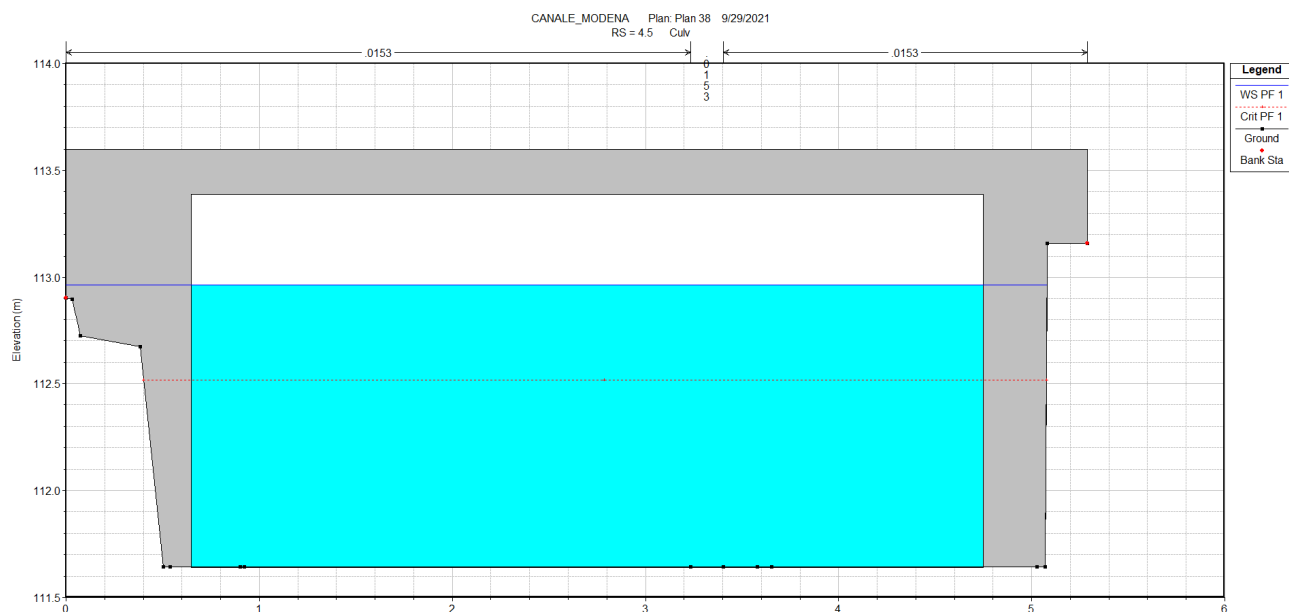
SEZIONE – INGRESSO CULVERT DI MONTE 410X175
